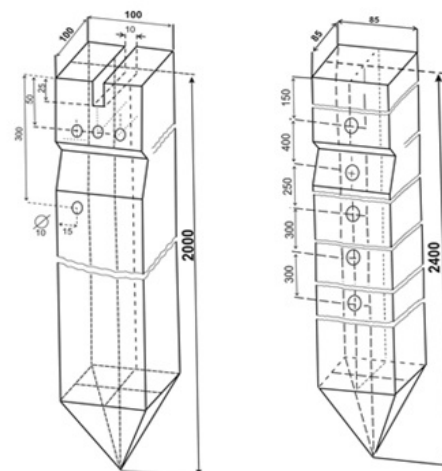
Вариант 1. Железобетонный столб длиной 2000 мм; Вариант 2. Железобетонный столб длиной 2400 мм
